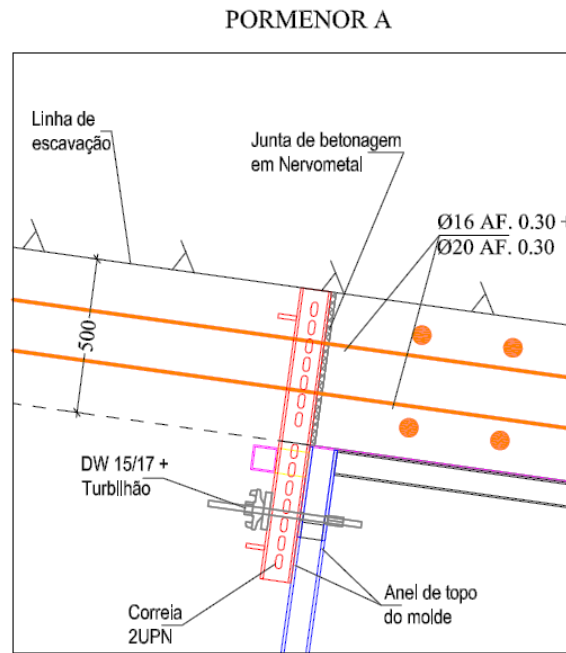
Pormenor das juntas de betonagem (Fonte: Projeto da cofragem)
